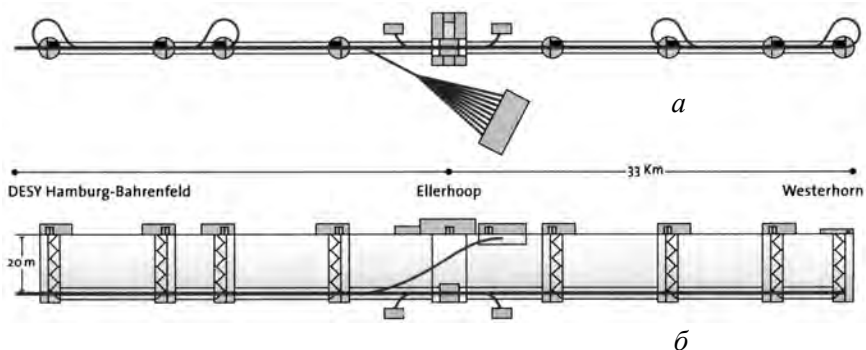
План и разрез комплекса TESLA: *a* – план; *б* – разрез
